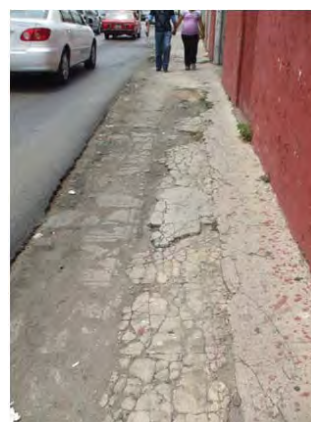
Acera en mal estado de conservación. Foto: R. Canché
